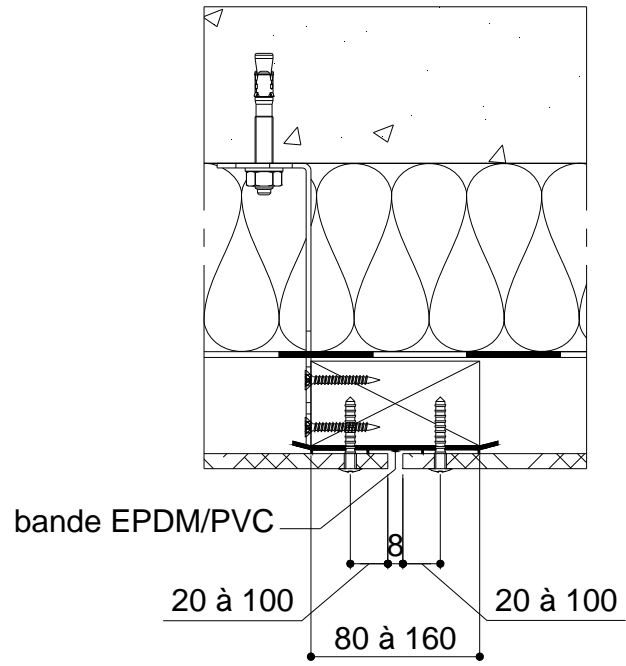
Joint vertical (coupe horizontale) sur ossature bois (cote en mm)
